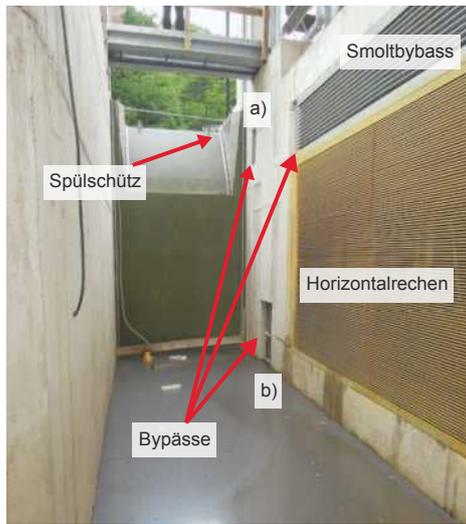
Einlaufbauwerk der WKA mit Horizontalrechen und Smoltbypass, a) oberflächen- und b) bodennahem Bypass sowie Leerschuss mit Spülschütz
